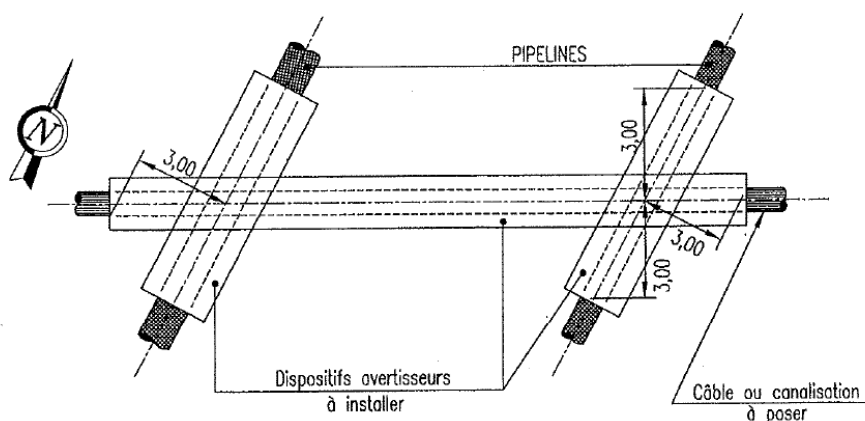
Plan type pour pose en croisement d'une canalisation enterrée par rapport aux pipelines
